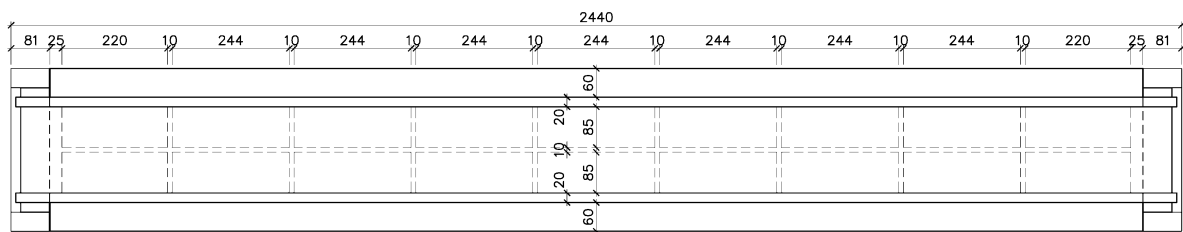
Projeto estrutural: planta. Dimensões em (cm)
